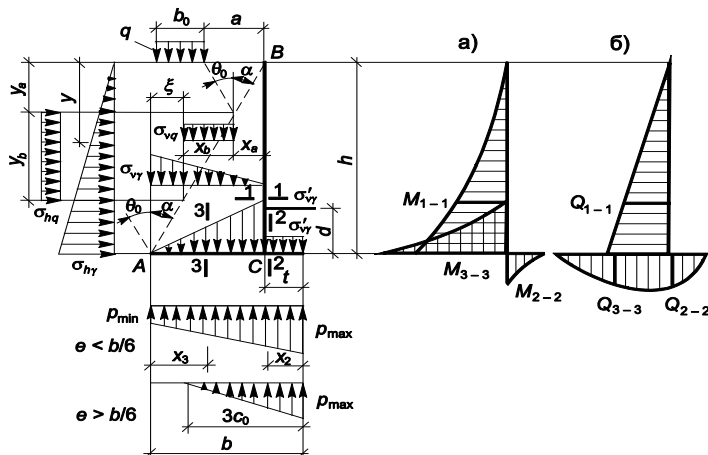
Расчетная схема подпорной стены уголкового типа при расчете ее на прочность:
